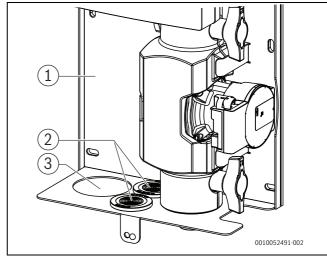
Passage des câbles et conduites à travers la tôle de fond
